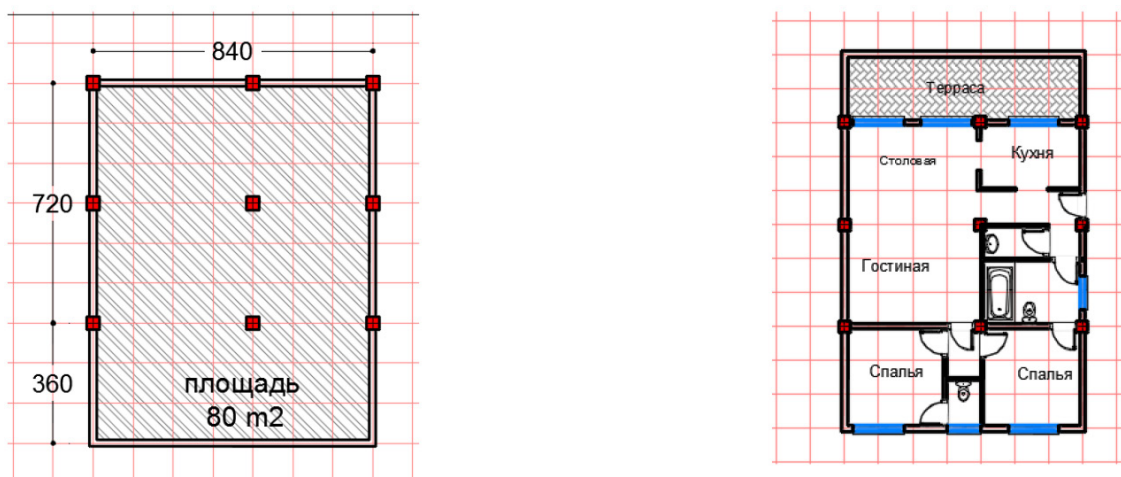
Планировочная схема одноэтажной квартиры в форме прямоугольника
